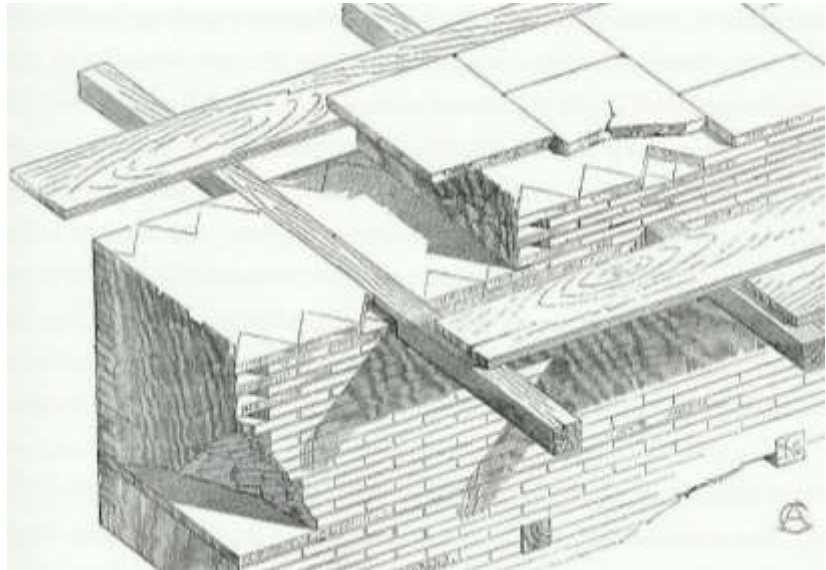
Detalle de la construcción un muro de tres hojas. Imagen 7 en Choisy (1999:21).
